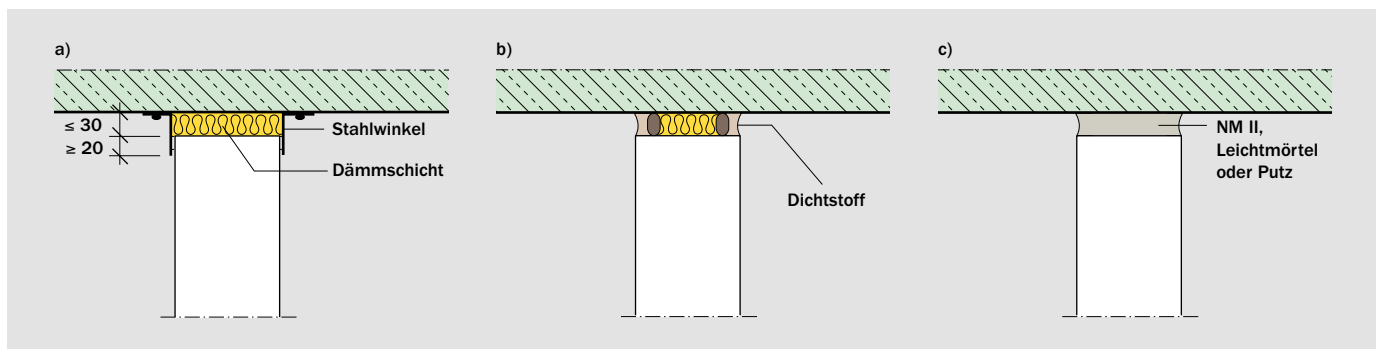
Obere Anschlussvarianten einer nicht tragenden Wand an die Geschossdecke
